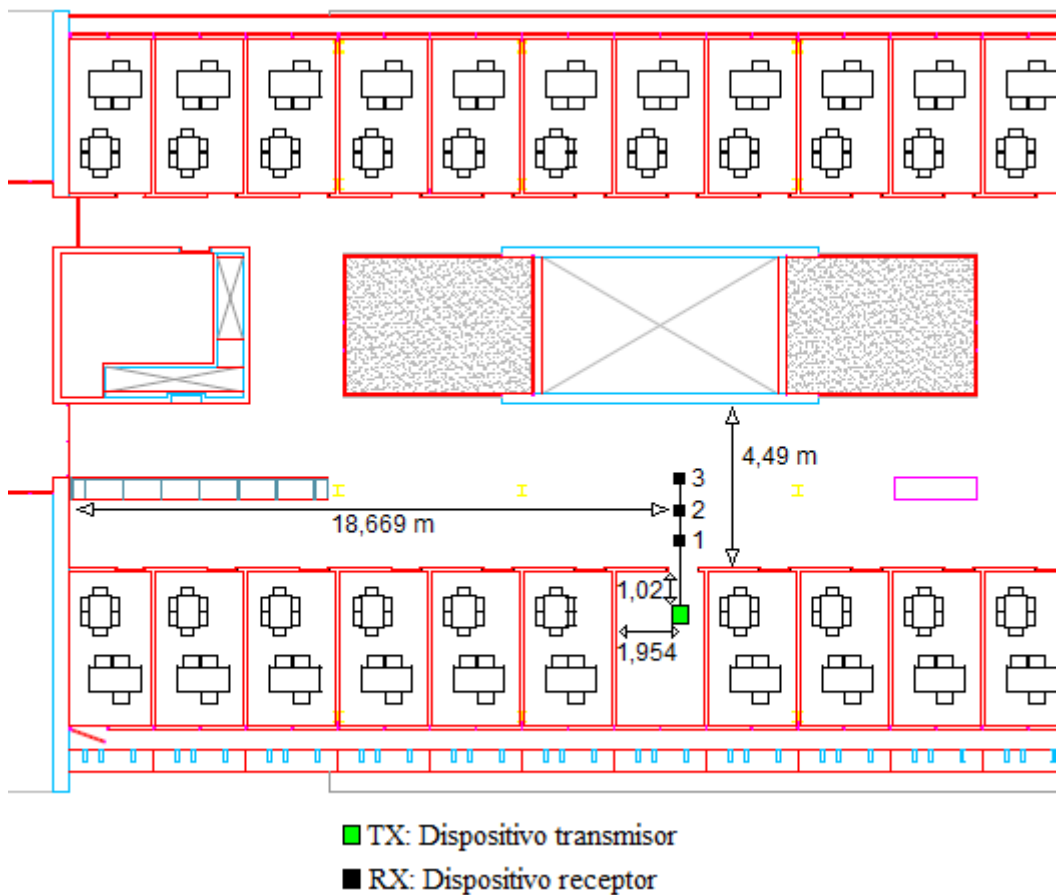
Plano detallado de la posición de los dispositivos en las medidas con la puerta abierta y el muro del despacho de por medio.
